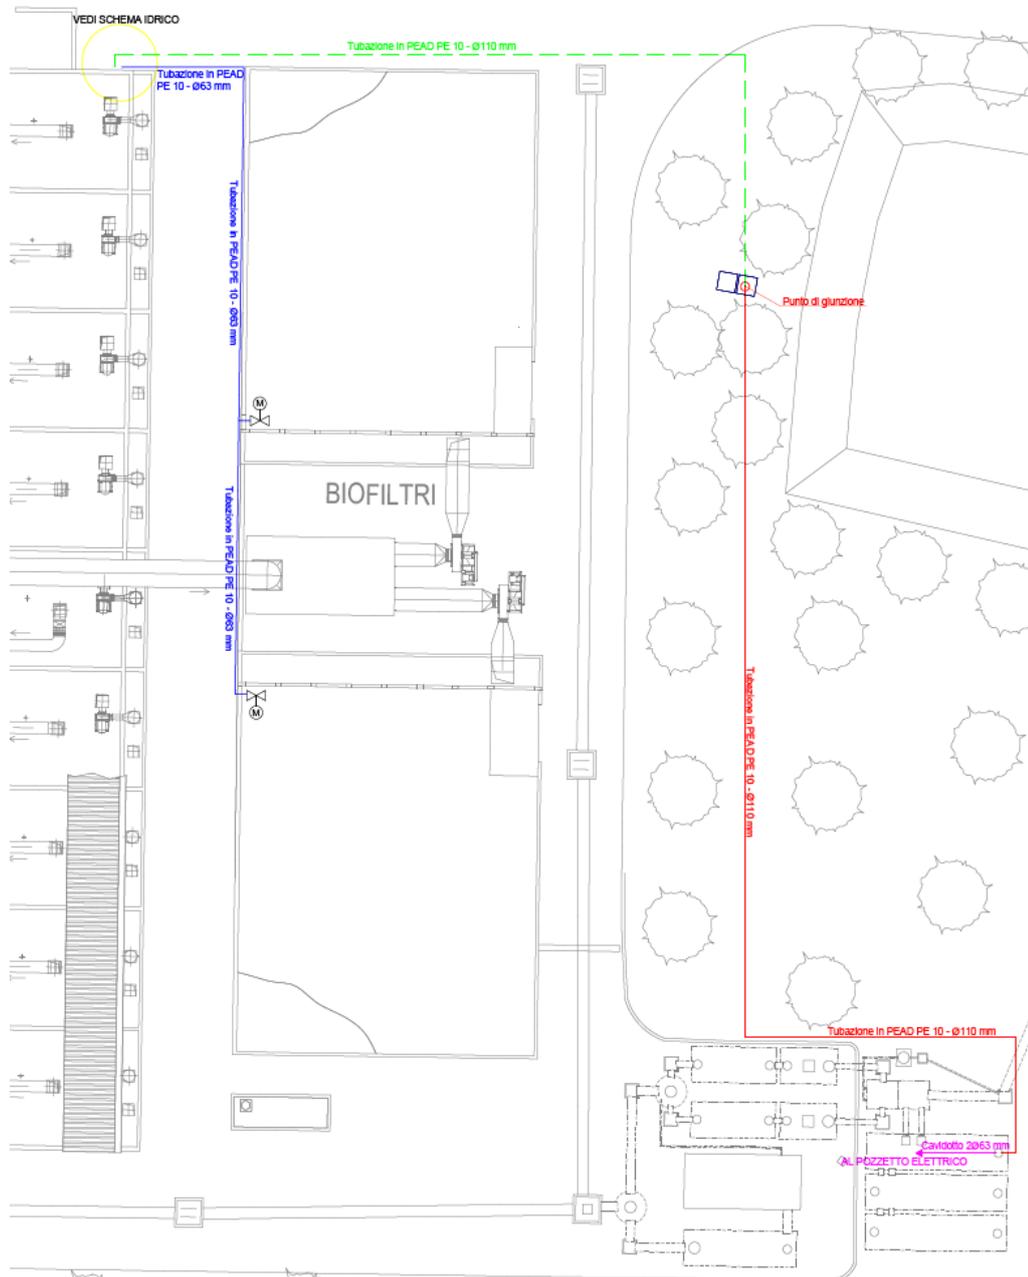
Planimetria riutilizzo acque meteoriche trattate Area Sud
